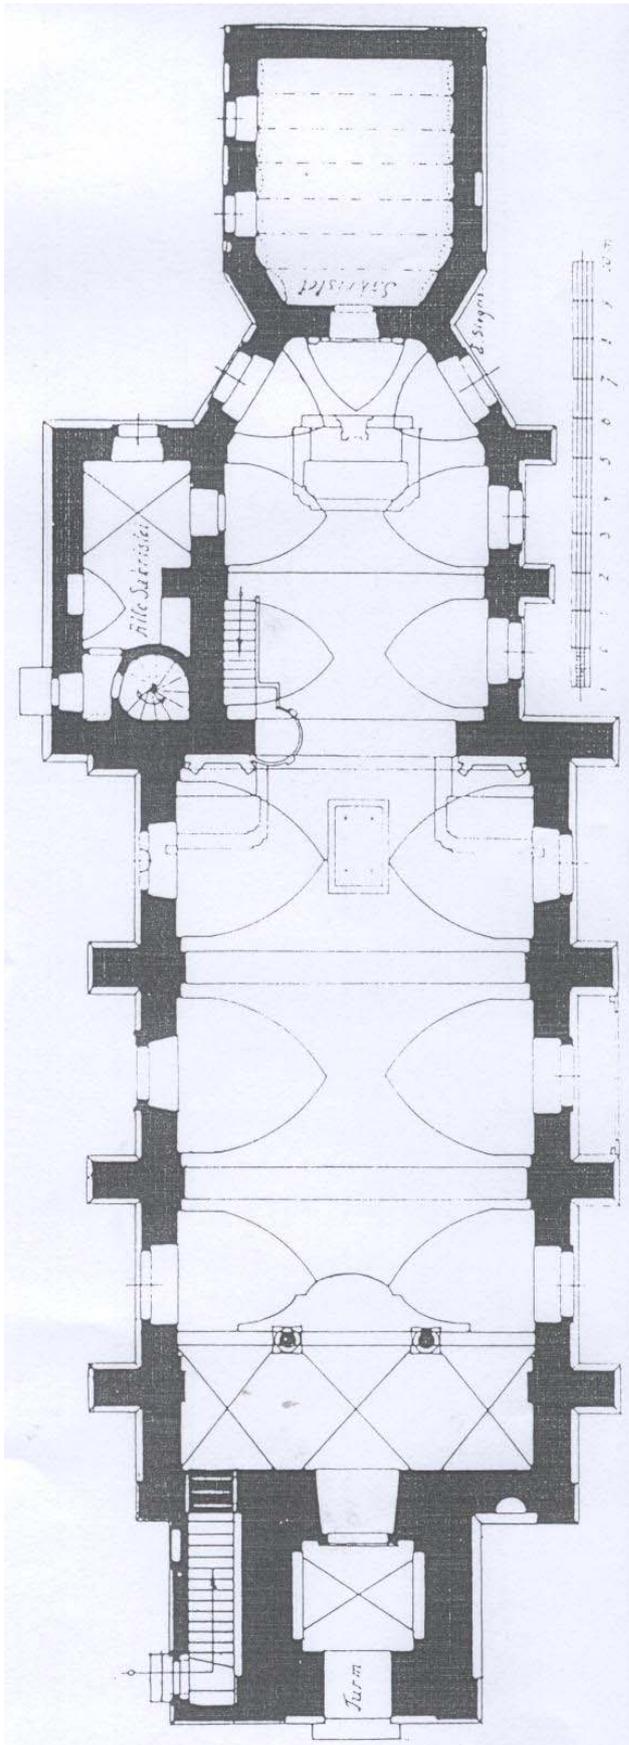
, Grundriss 8, Purbach, Pfarrkirche³³⁰
